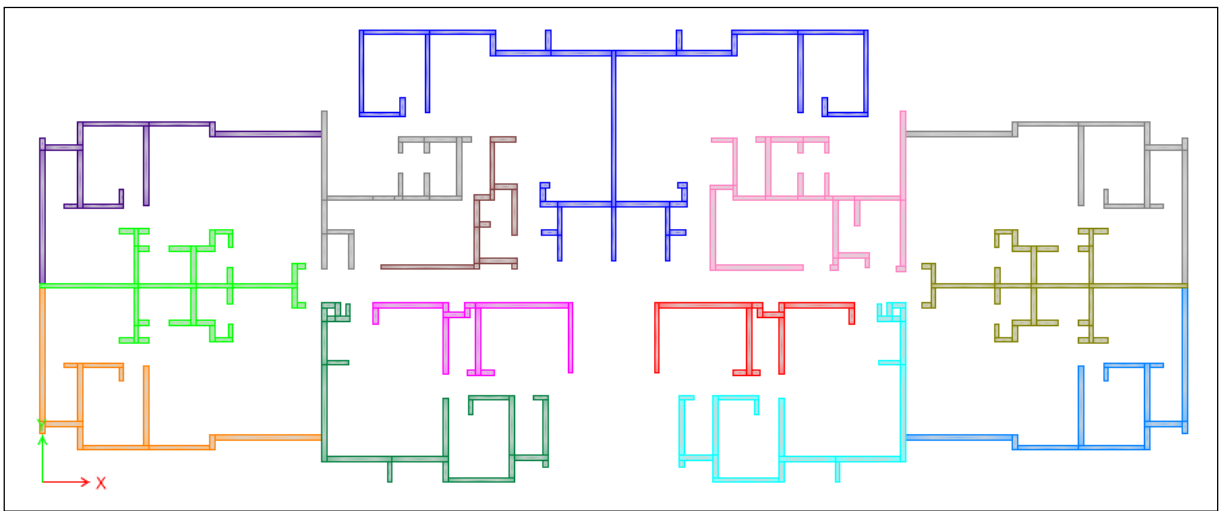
Vista en planta del Edificio L (elementos tipo barra de sección transversal irregular)
